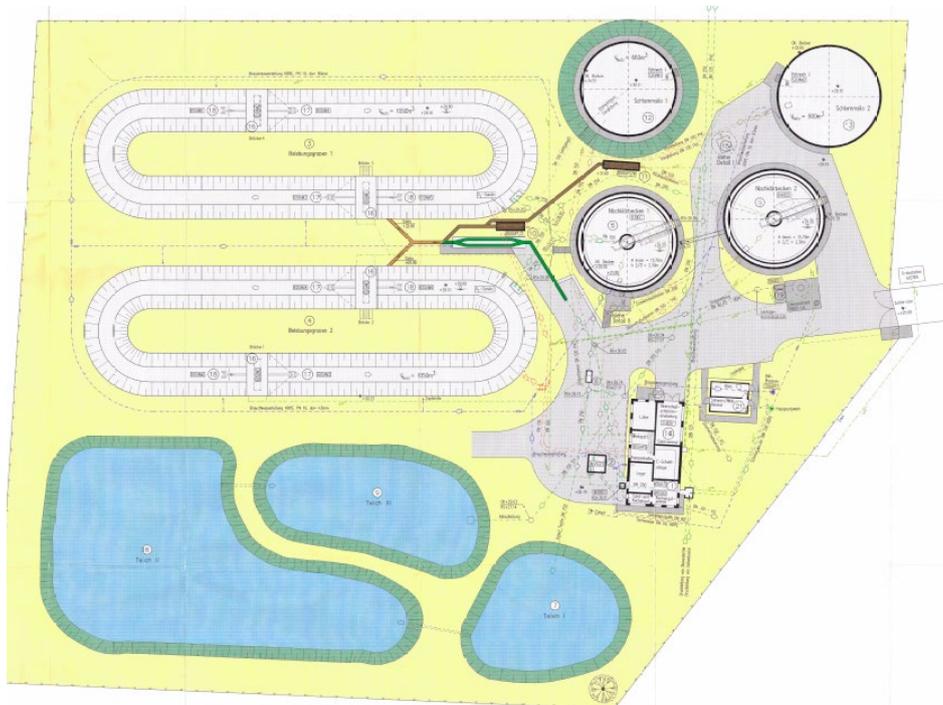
Lageplan KA Bienenbüttel Bestand
